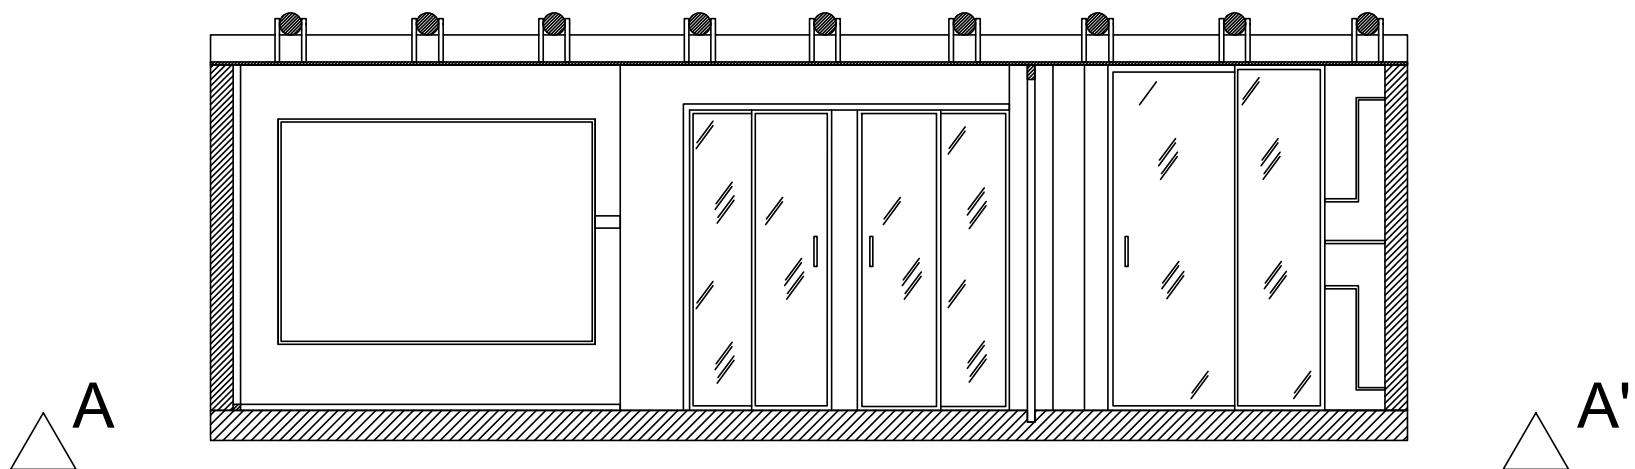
Planta de propuesta. (Romero, 2018). Esc: 1.125
